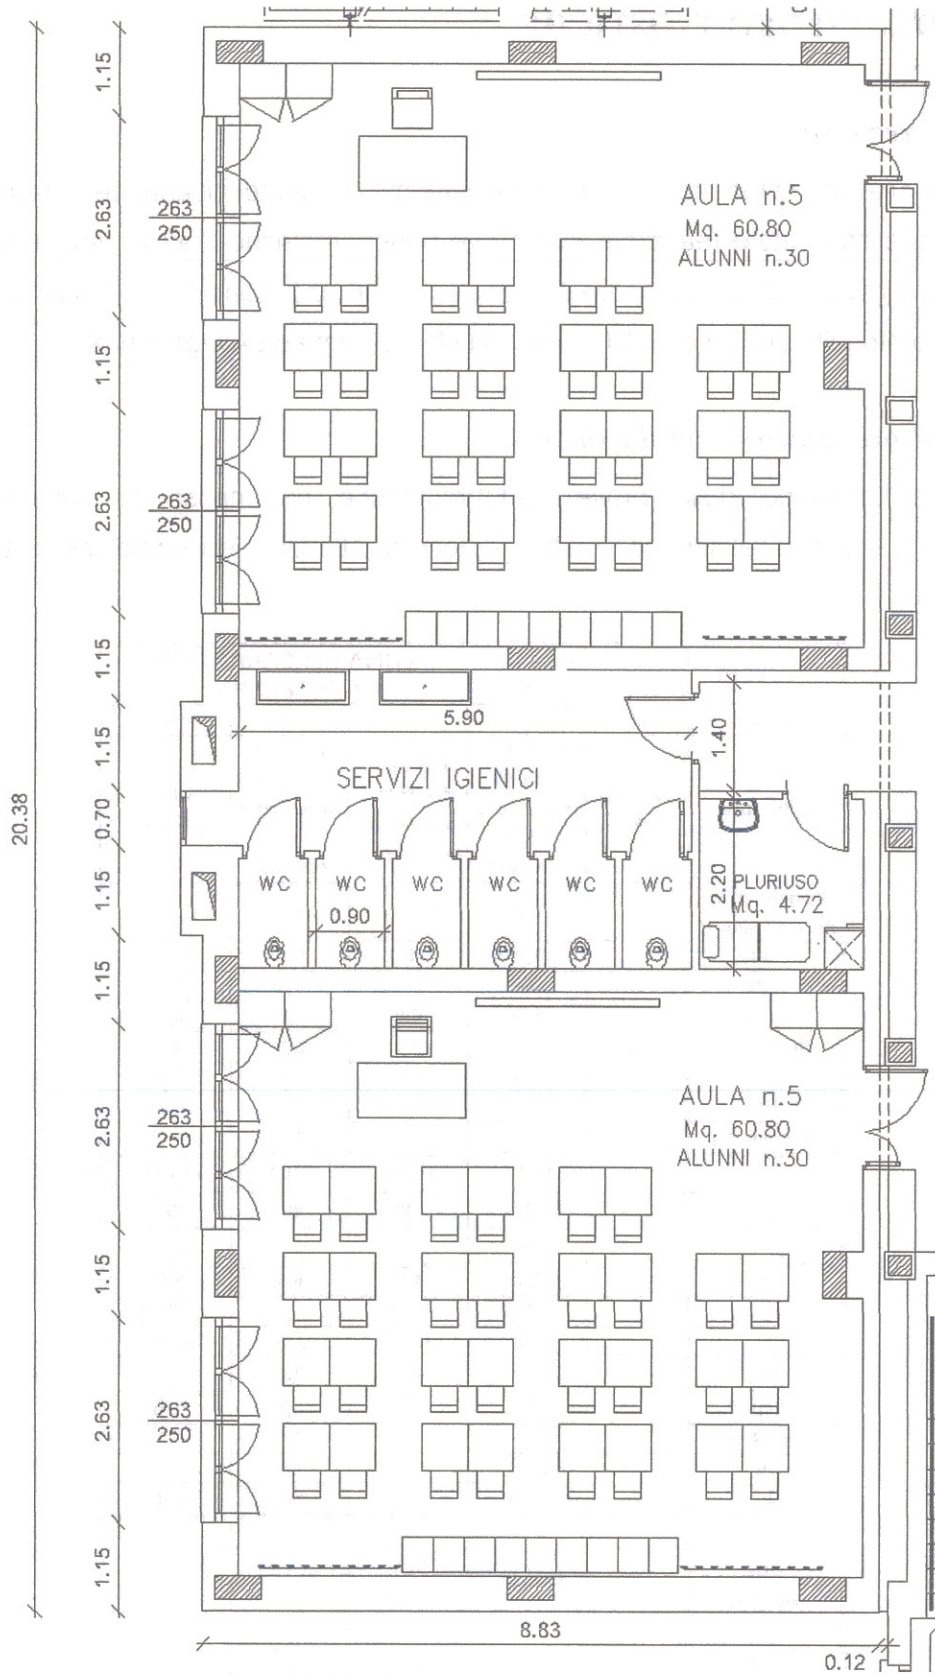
Planimetria di aule e WC (fuori scala)
